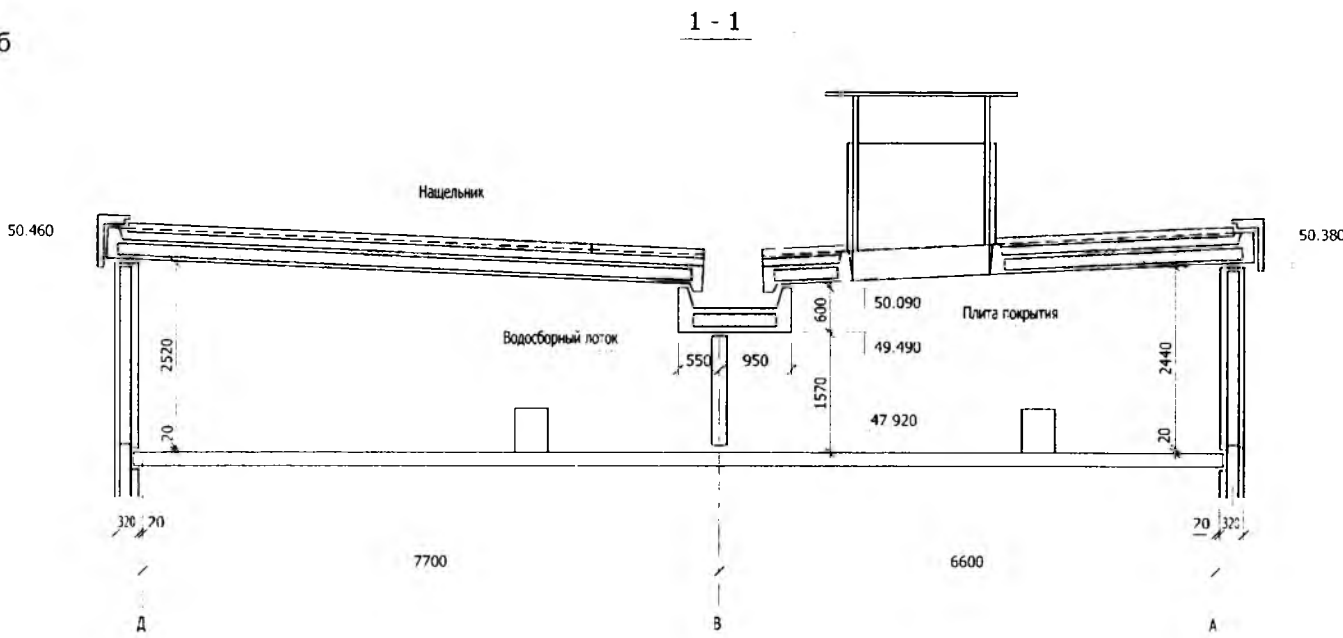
Конструктивное решение теплового чердака с безрулонной кровлей 16-этажной рядовой блок-секции
